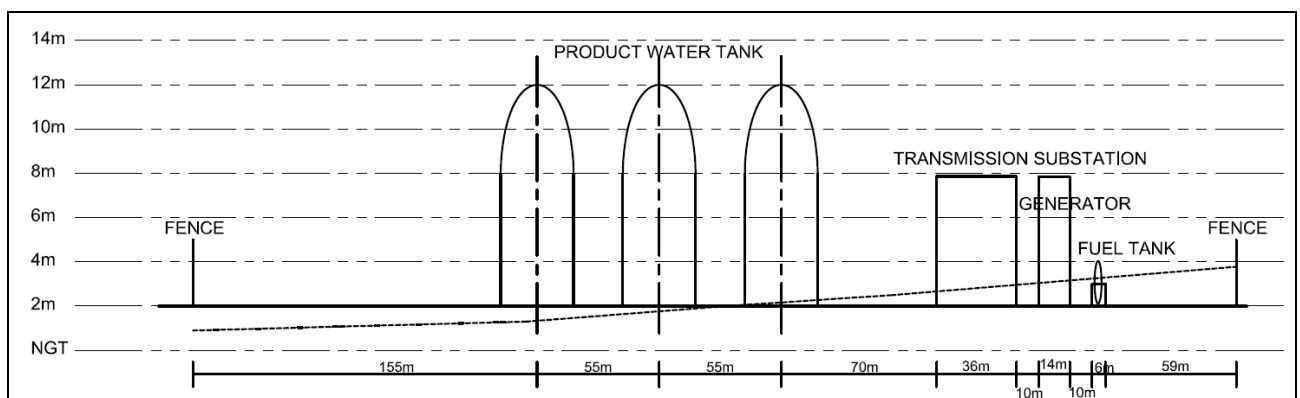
Plan d'implantation des ouvrages de la station de dessalement
